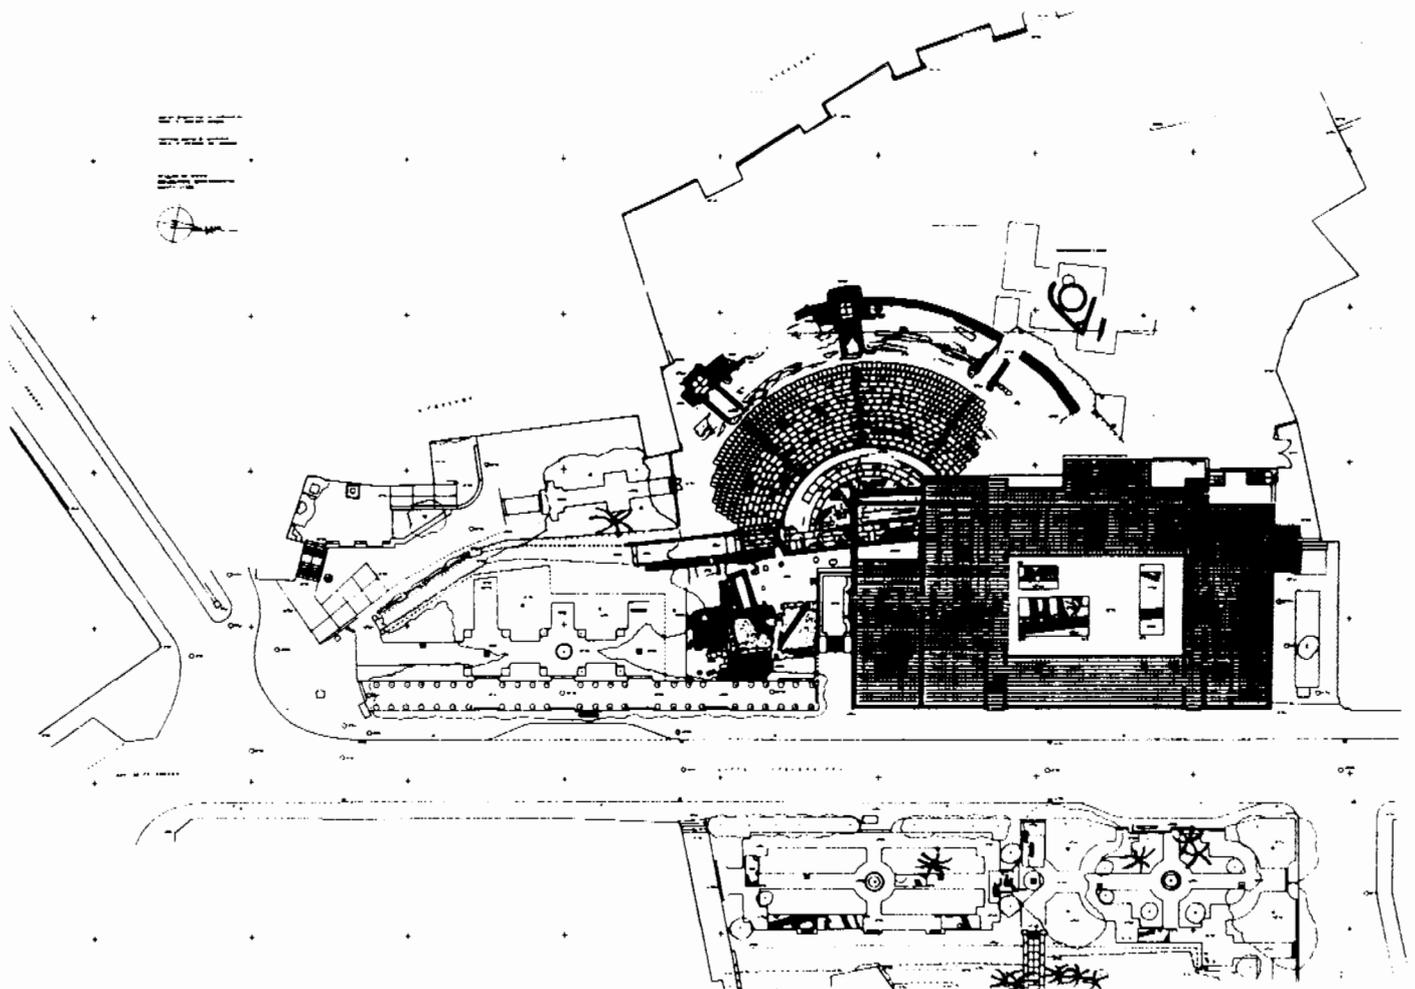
Emplazamiento del teatro romano de Málaga con indicación de las zonas excavadas en él y en los jardines de Ibn Gabirol.
